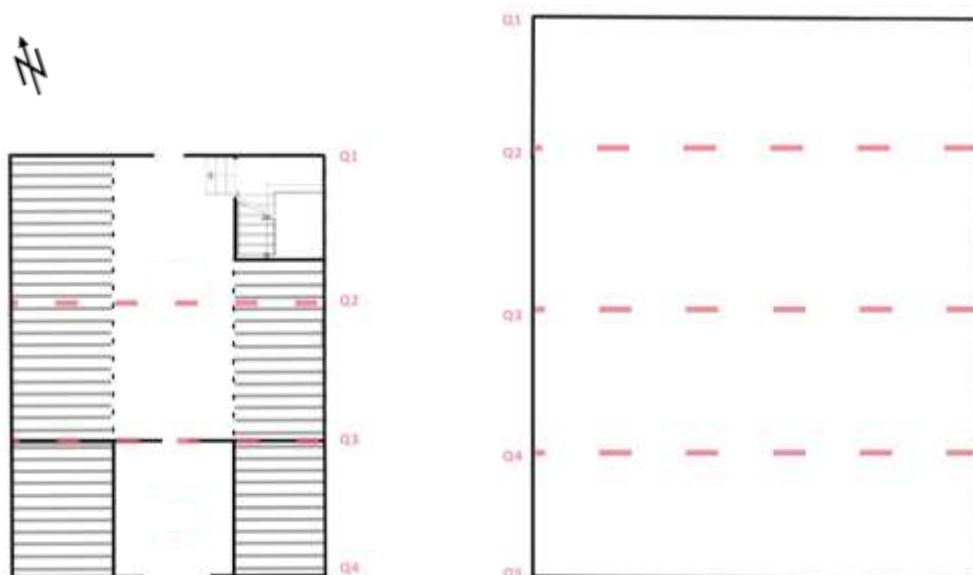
Schematischer Grundriss, Dachwerk des Wohnteils und der Ökonomie. Bearbeitung IBID.
